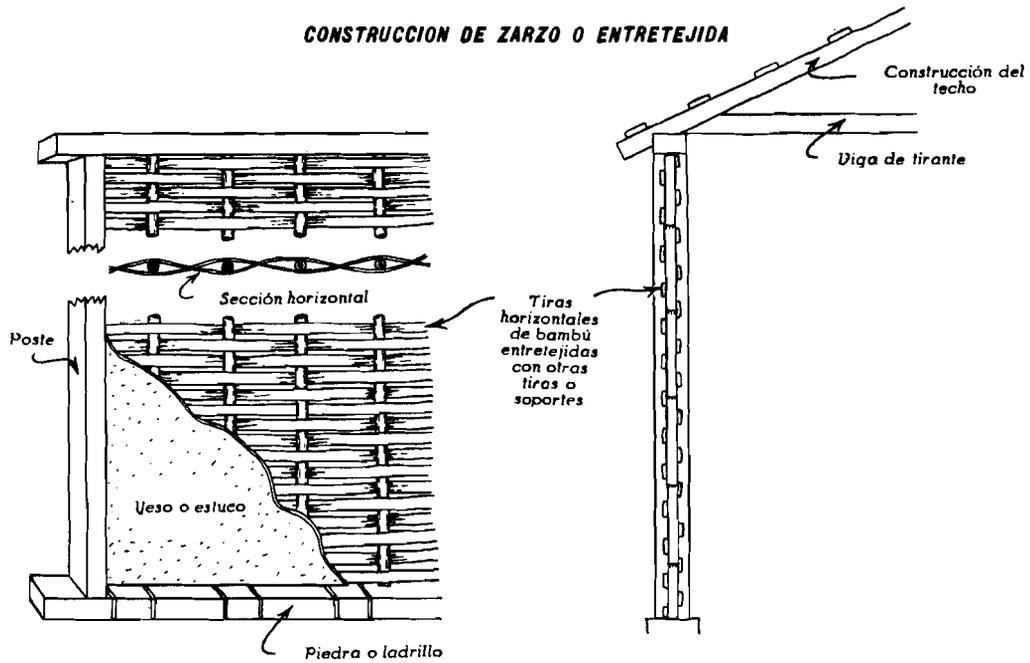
Dos tipos de construcción de muros en los que se emplea el bambú.
